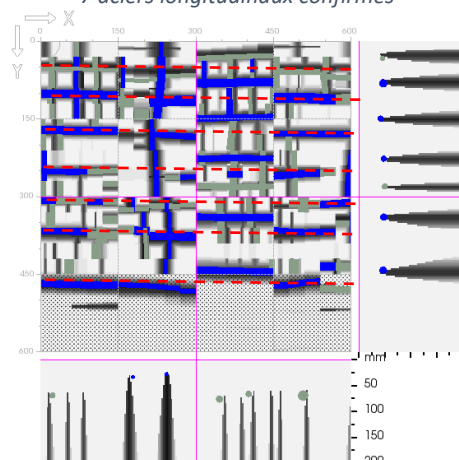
Poutre Pt05 – Travée 4 à mi-travée
